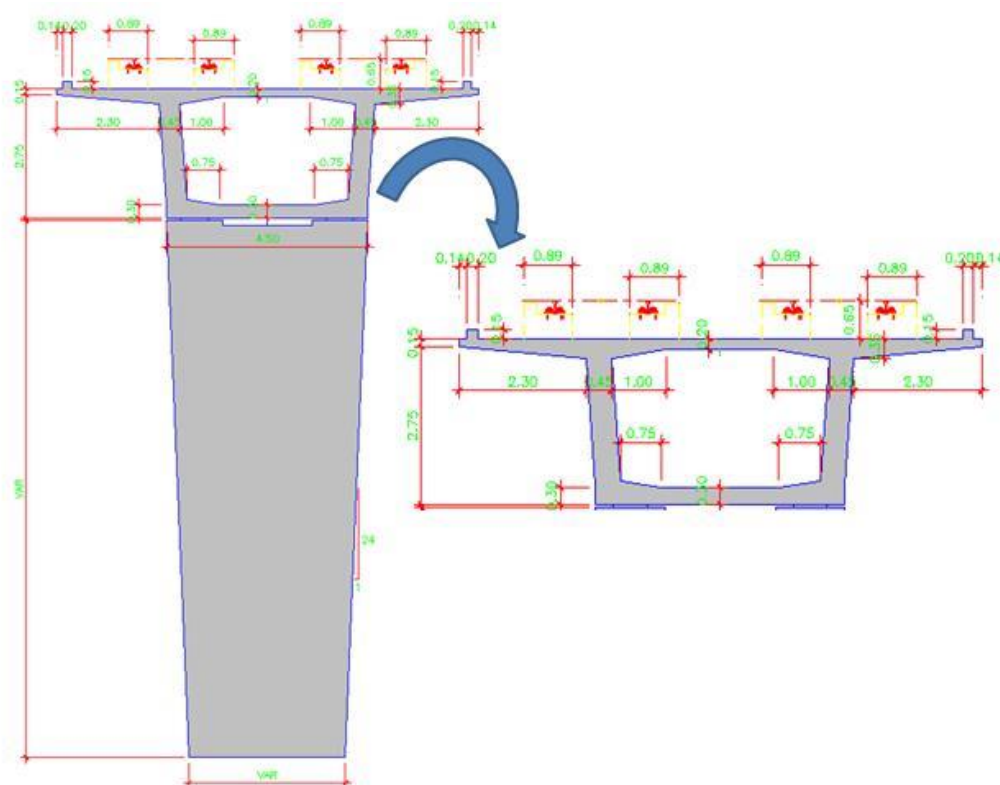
Ilustração do Conjunto da Meso e Superestrutura do Elevado.
